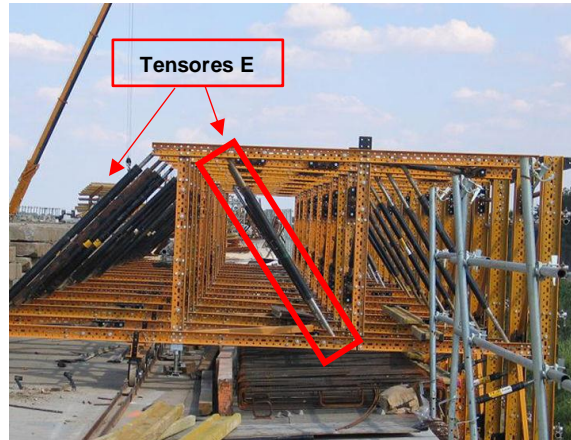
Tensor E en estructura compuesta por Riostras MK. [Foto gentileza de ULMA Construction].
